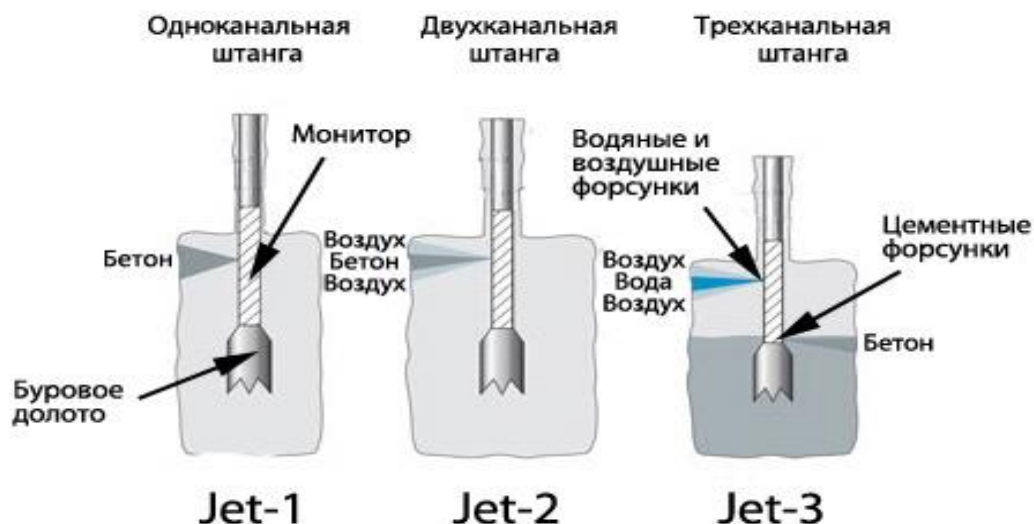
Создание грунтобетона с помощью систем Jet-1, Jet-2 и Jet-3.
